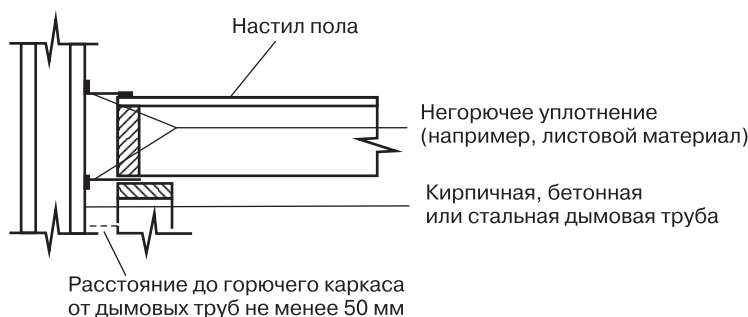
Расстояние от стенок камина до каркаса здания
